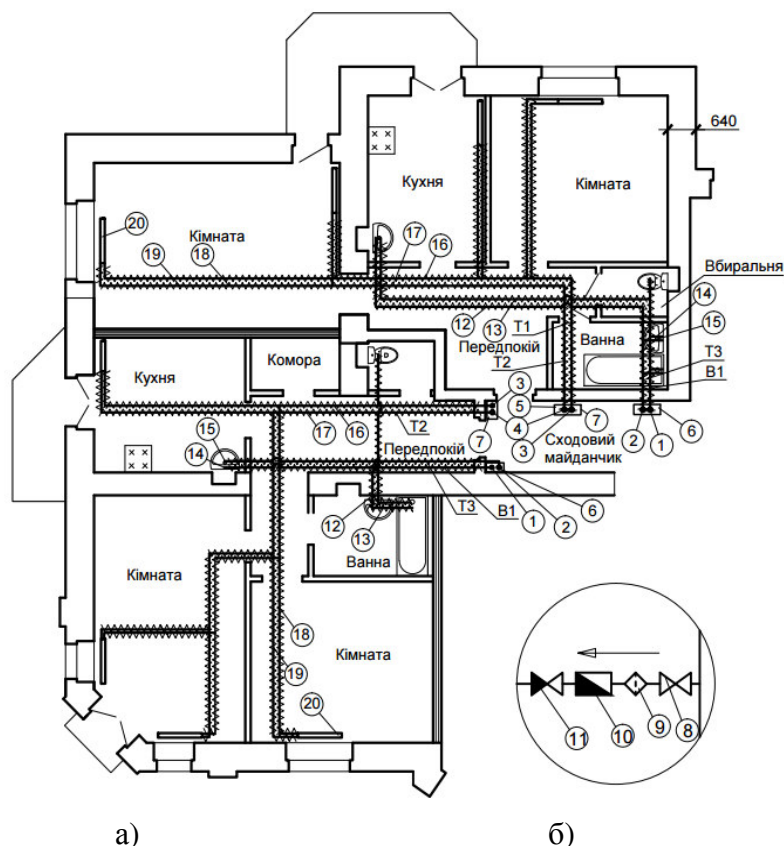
План розташування трубопроводів холодного, гарячого водопостачання і тепlopостачання з вузлами обліку води в металевих шафах на сходовому майданчику двох суміжних квартир (а) та схема вузла обліку (б)
